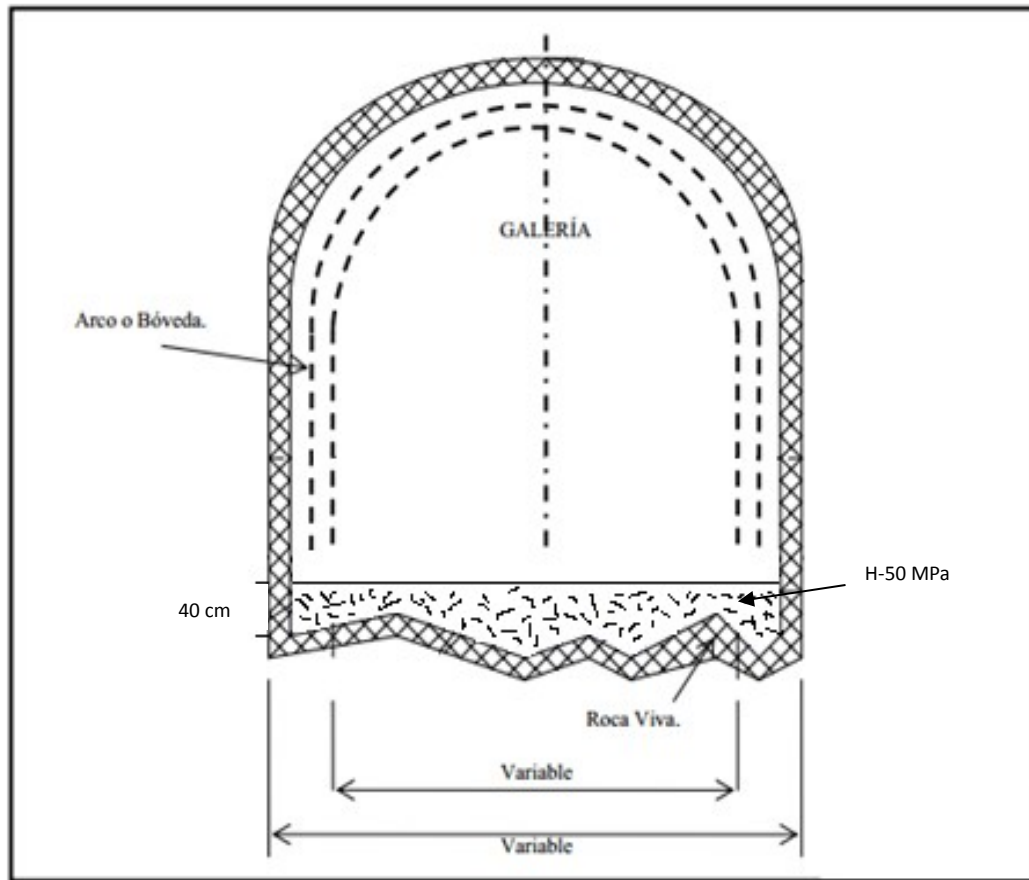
Galería confeccionada con hormigón H-50 MPa espesor 40 cm [Fuente: Elaboración propia, 2013.]
